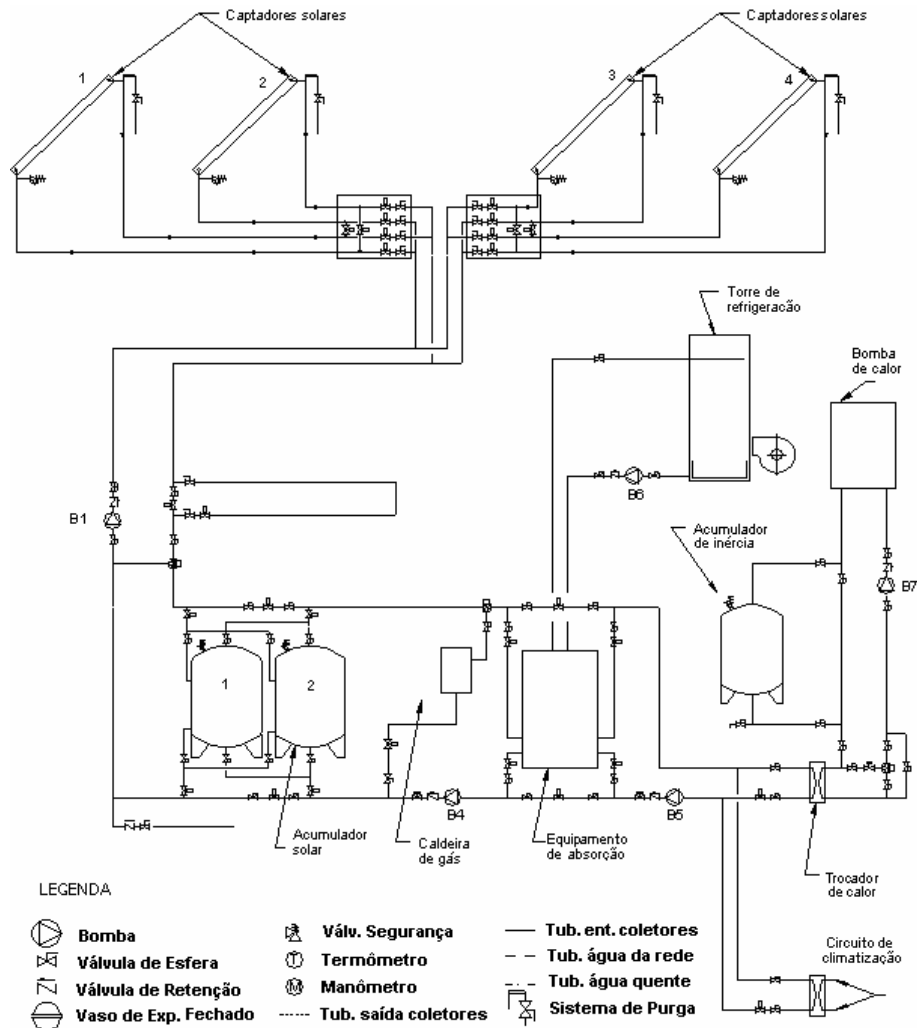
Esquema da Planta Solar de Refrigeração.
